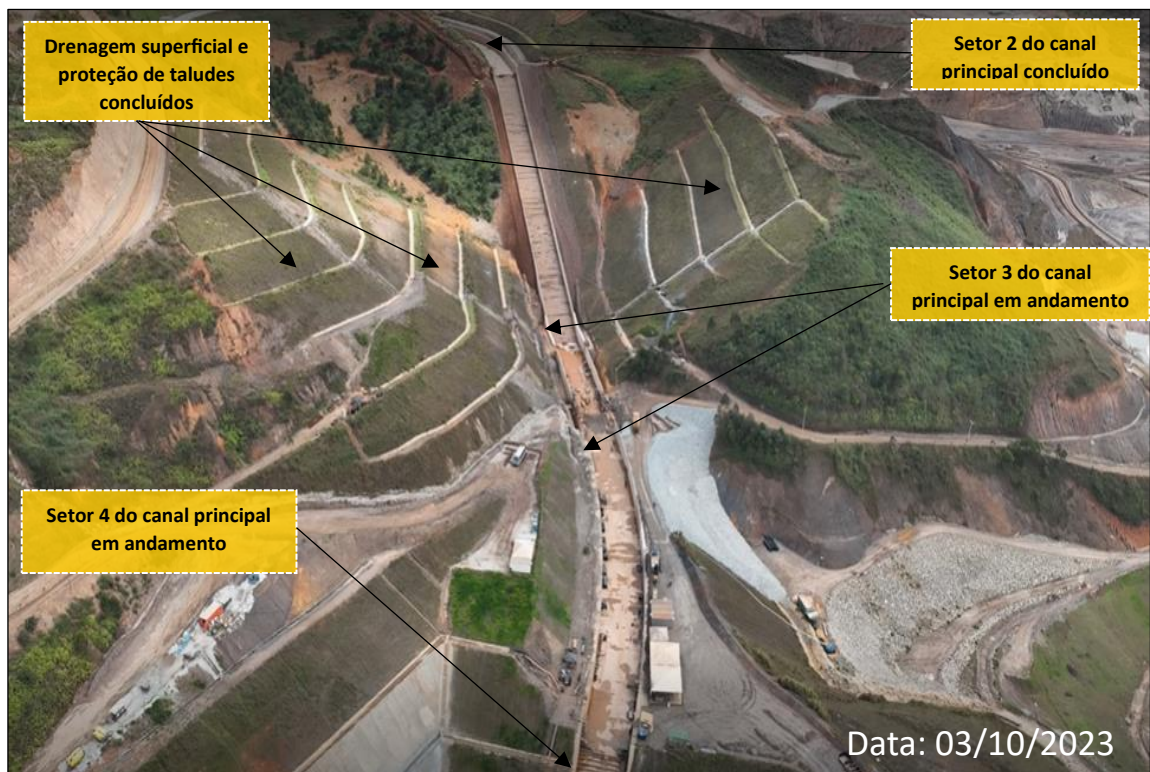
Vista do Setor 3 do Canal Principal – Paredes do Canal Em Andamento
